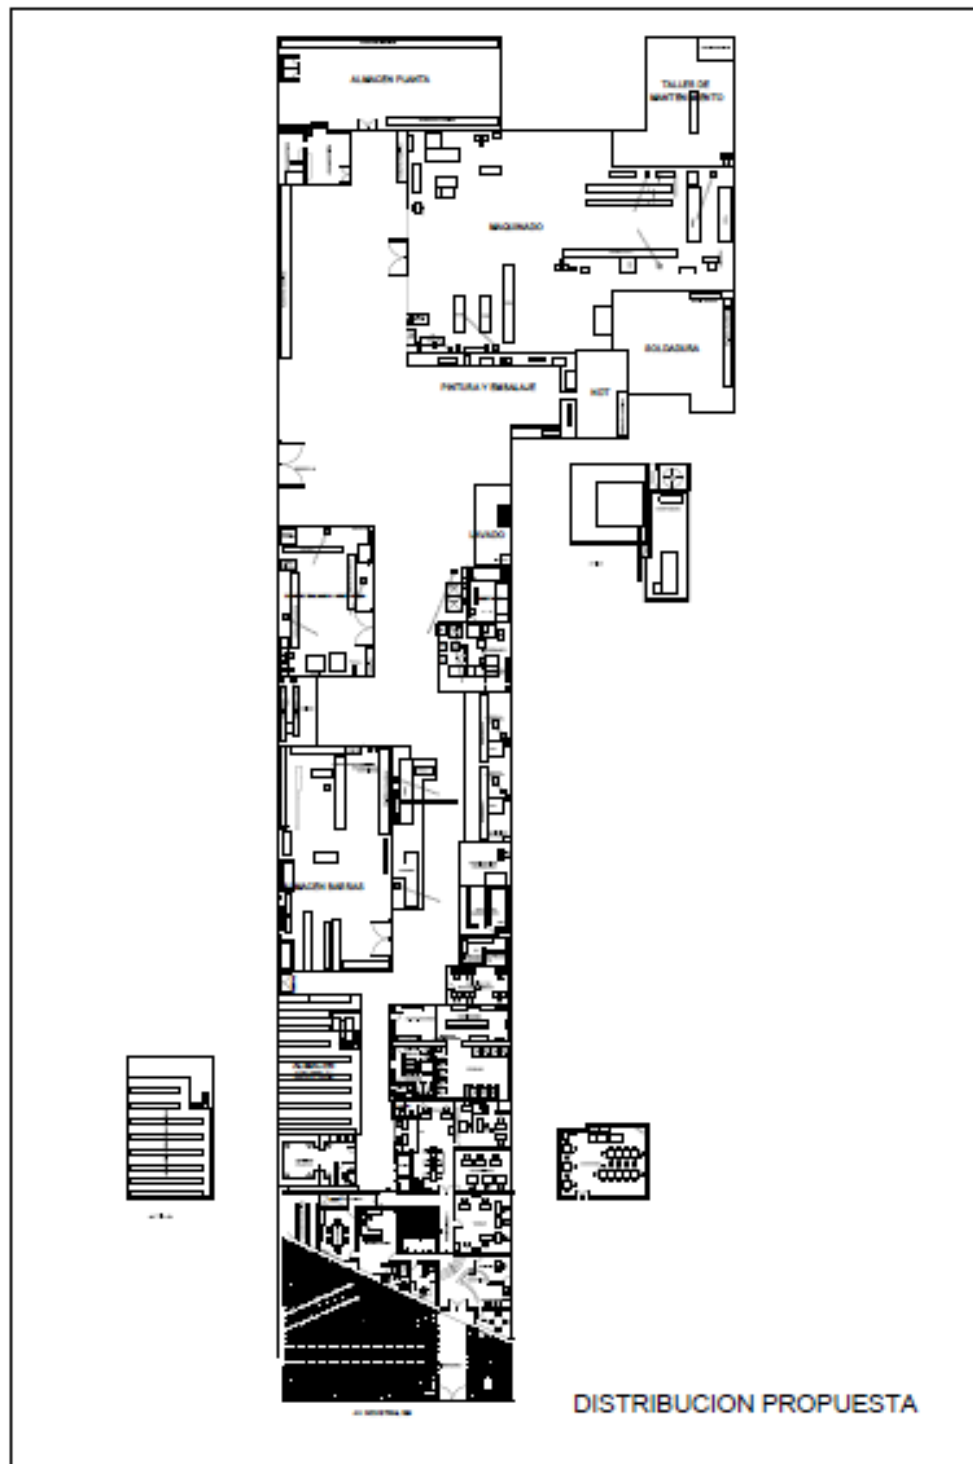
Plano propuesto de redistribución de planta. Fuente: Elaboración propia.
